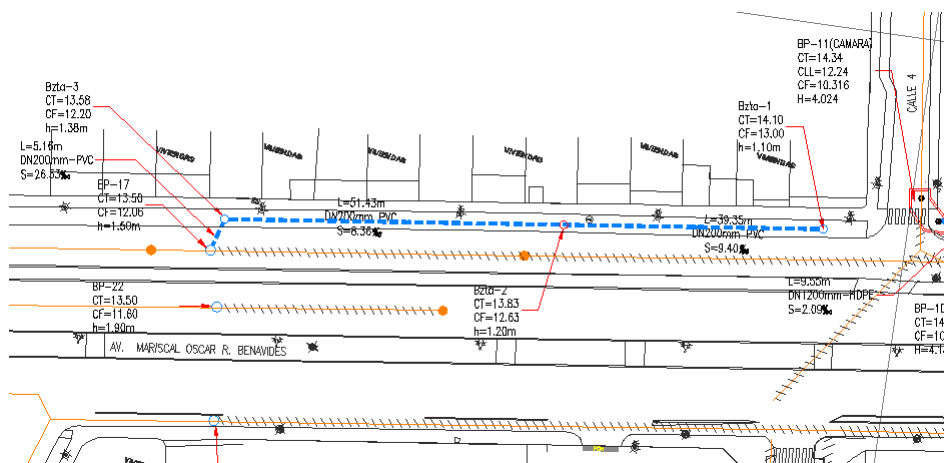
Proyecto Saldos de Obra de Reubicación de redes de Alcantarillado - E2
